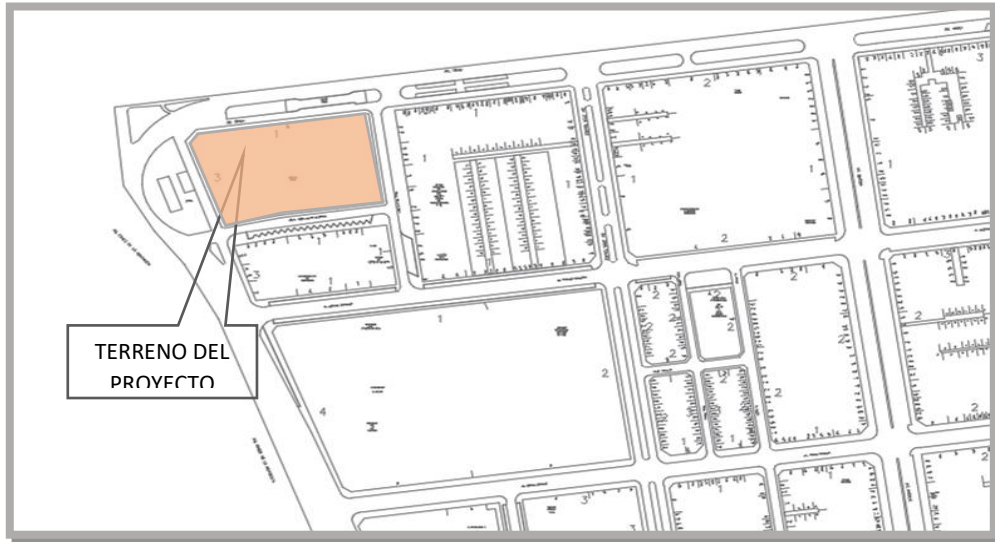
Plano de terreno del proyecto. Fuente: Elaboración propia
